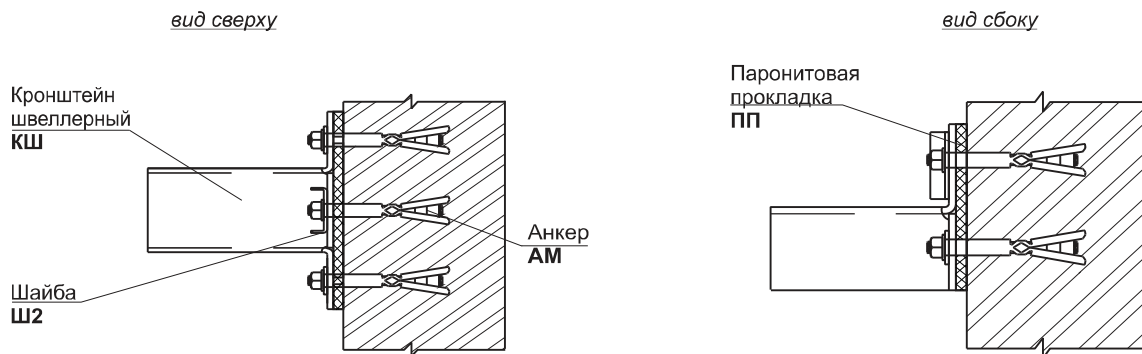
Узел крепления кронштейна КШ к стене тремя анкерами.
